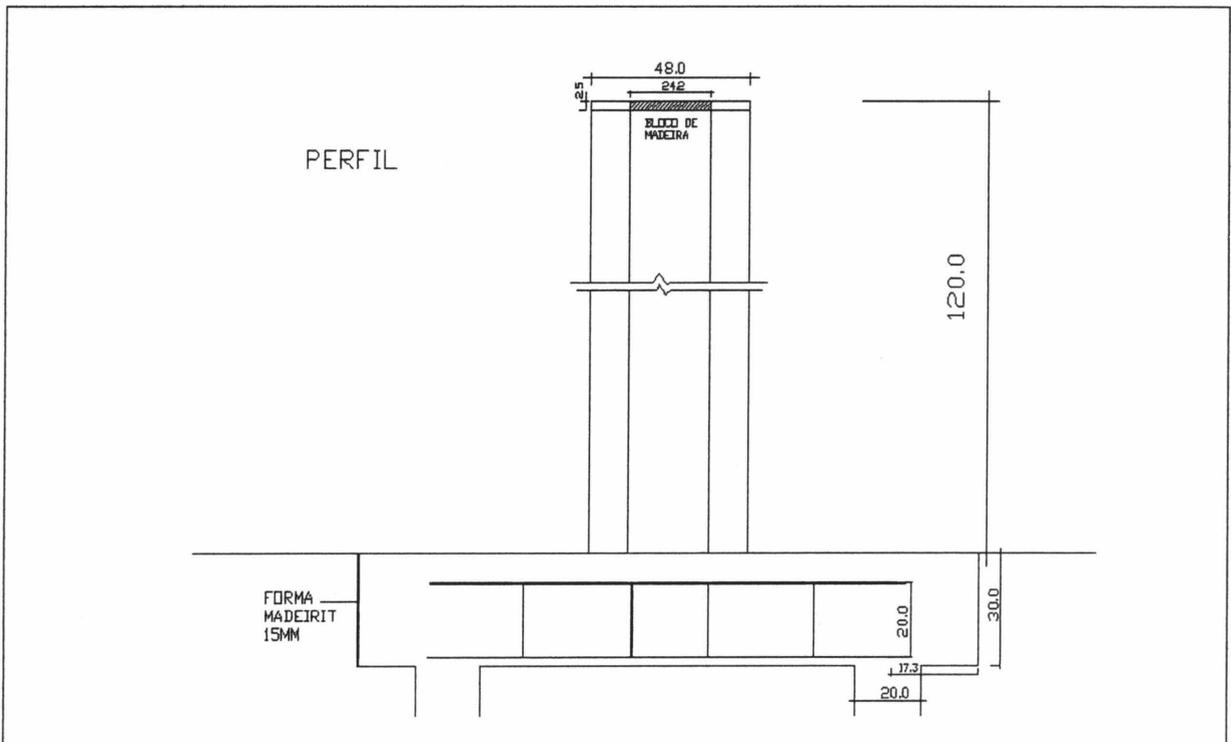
Esquema do pilar com dispositivo centragem forçada.
